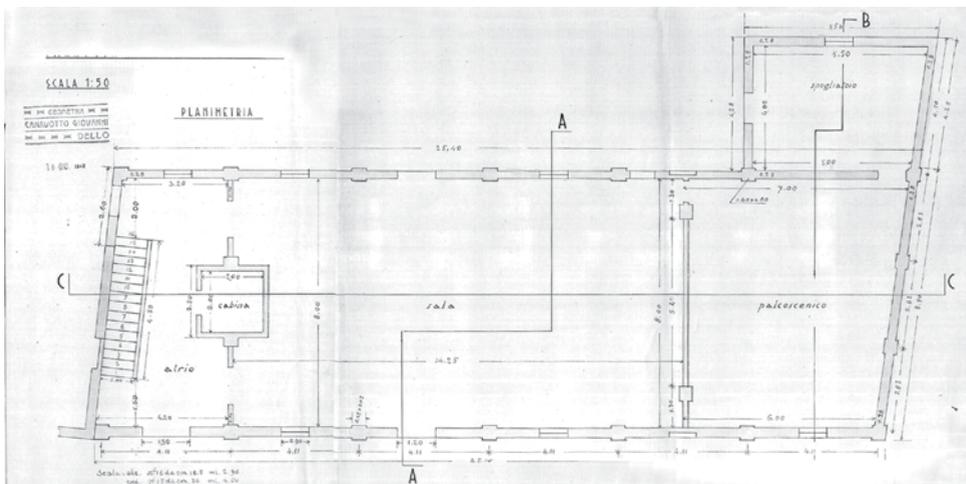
Giovanni Canavotto, progetto di teatro per la parrocchia di Quinzanello, planimetria (AP Quinzanello, 7).
